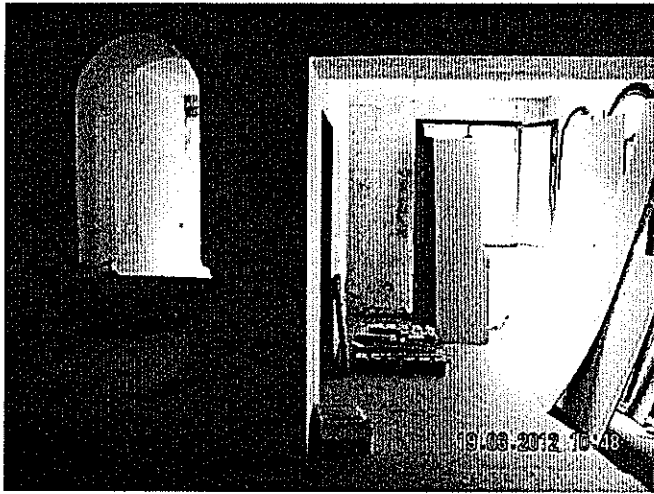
Stanza 8- Vista parete lato stanza 10 e secchiaio storico in pietra.
